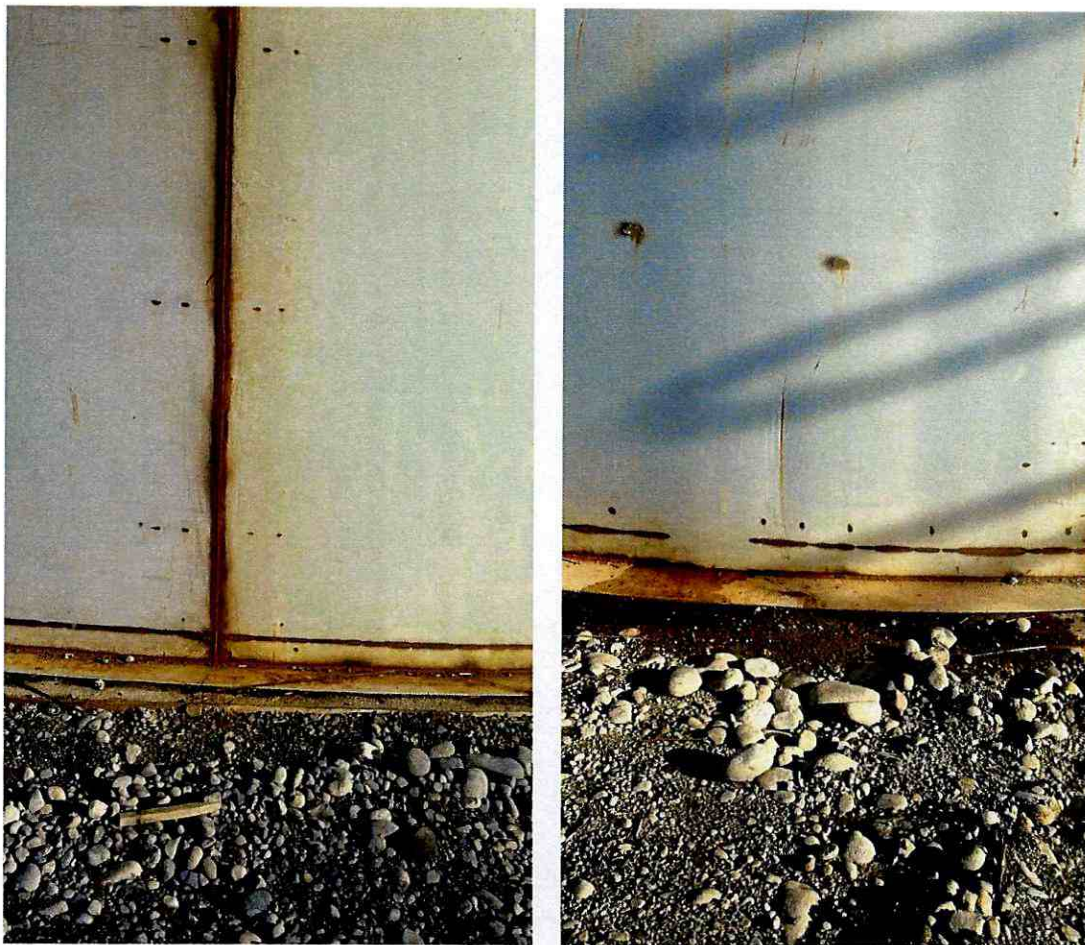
Apoyo simple de las estructuras metálicas sobre radier de hormigón de 10 centímetros de espesor
